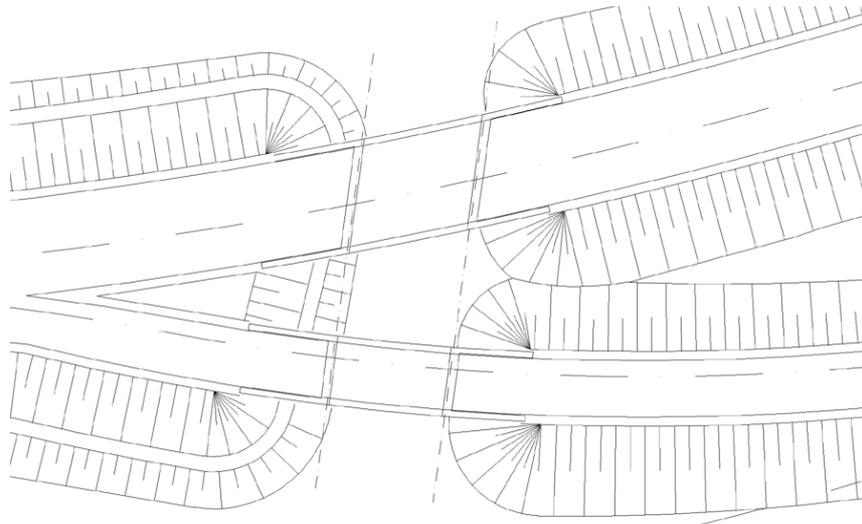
D Cavalcavia Viale Don Bianco - Pianta
